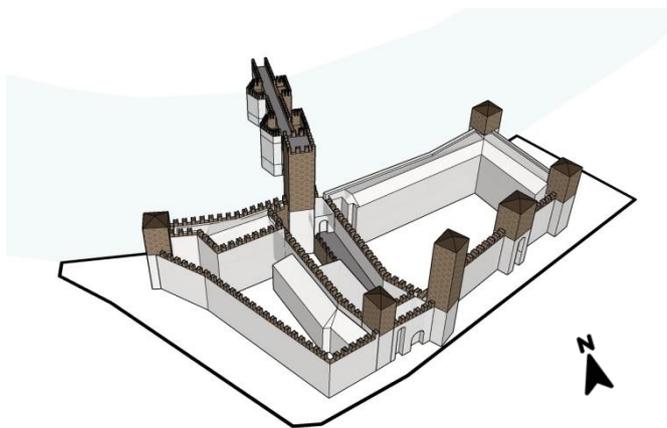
Castelo reconstruído, torres e coroamento das muralhas reconstruídas (1926)
